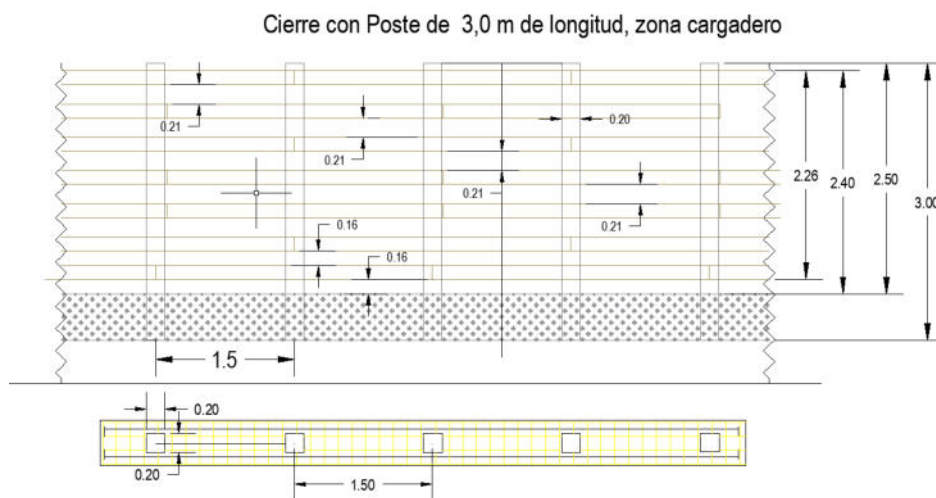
Perfil transversal del cierre en la zona del cargadero.
